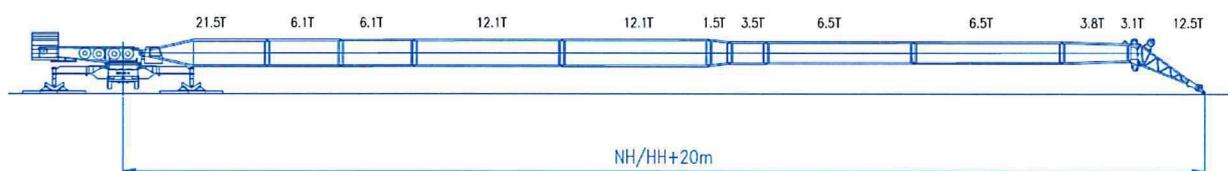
Mindestlänge der Fläche für die Montage des Kranauslegers (illustrative Funktion)
